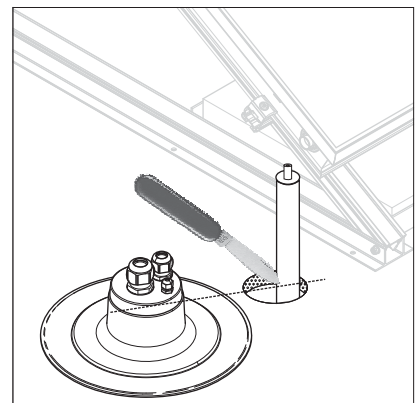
Passage de la conduite de raccordement directement au niveau du raccordement du capteur solaire.
